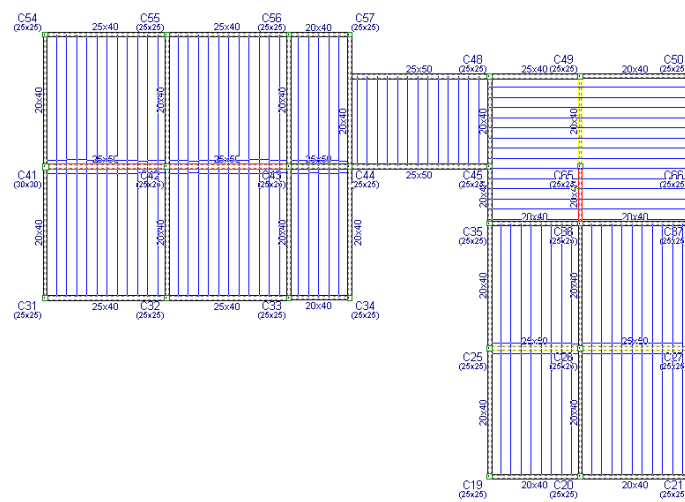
Cubierta Modulo Talleres y Laboratorios.
